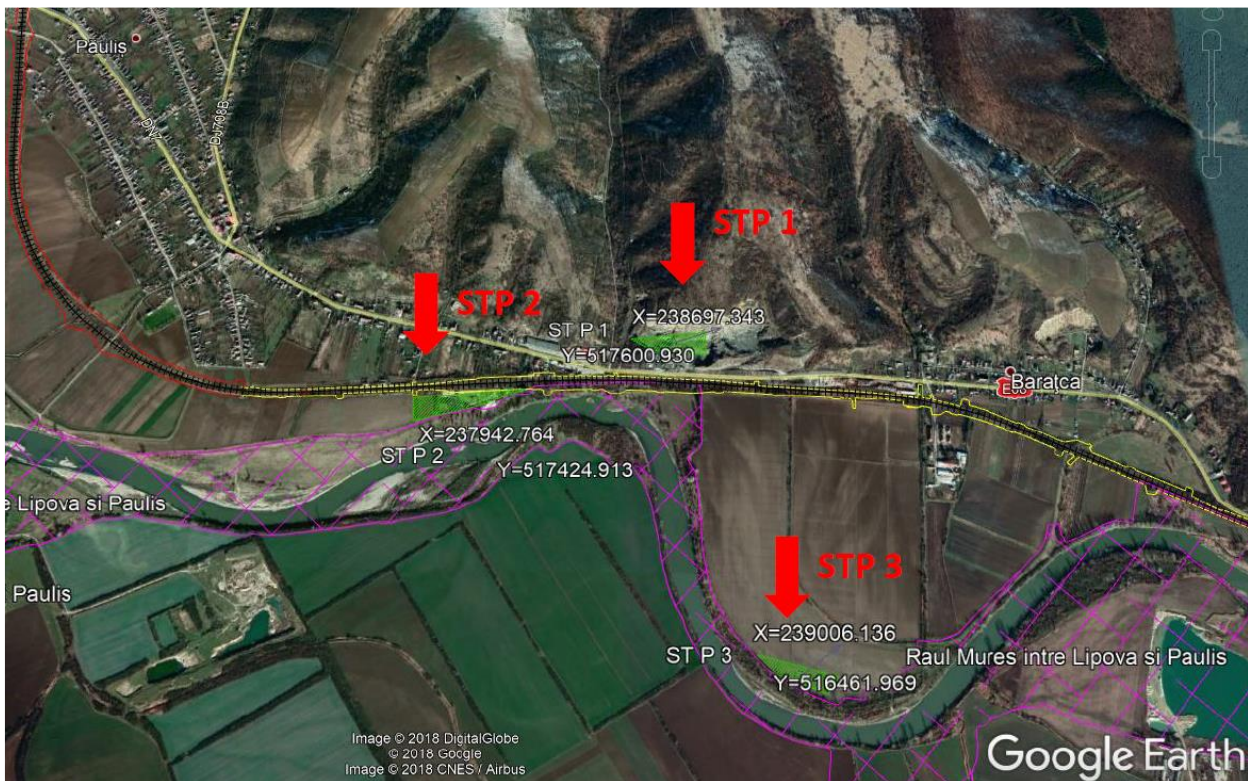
Plan de amplasament pentru platformele STP 1, STP 2, STP 3 – vedere din satelit
